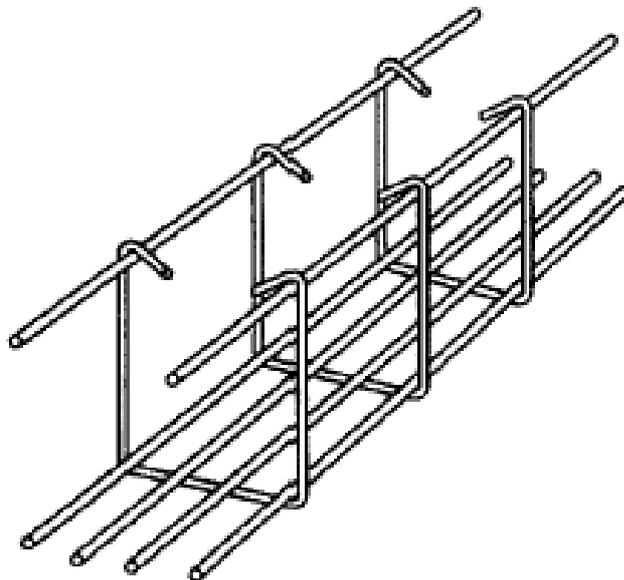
a) Refuerzo de una viga solicitada a cortante.
